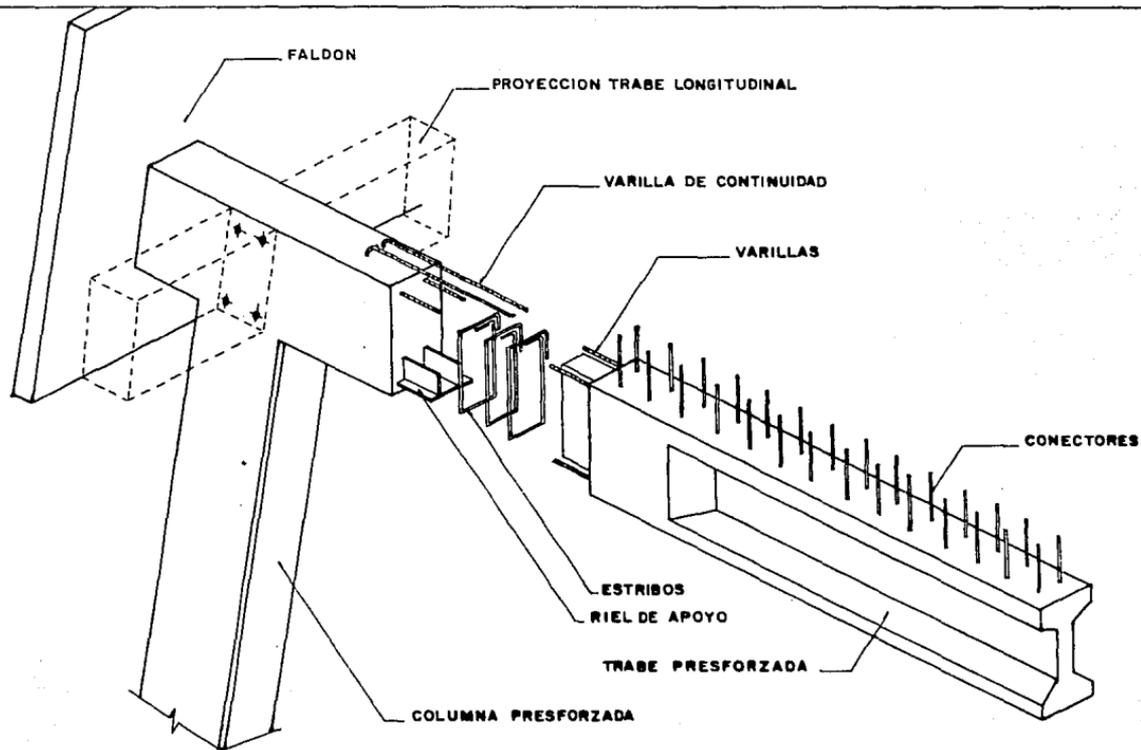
DETALLE DE UNION - COLUMNA TRABE TRANSVERSAL.
